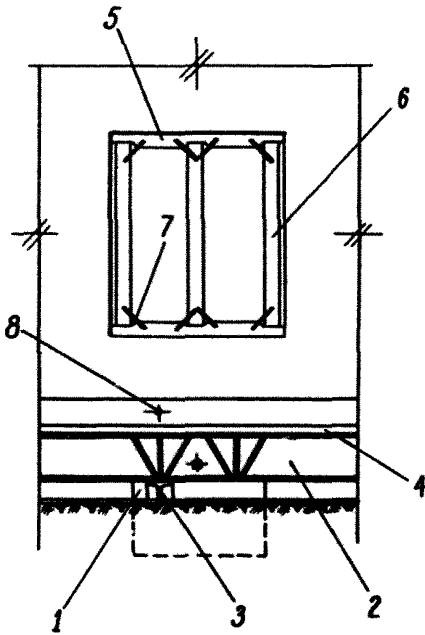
Схема усиления оконного проема (1 этажа), расположенного над домкратной нишей:
